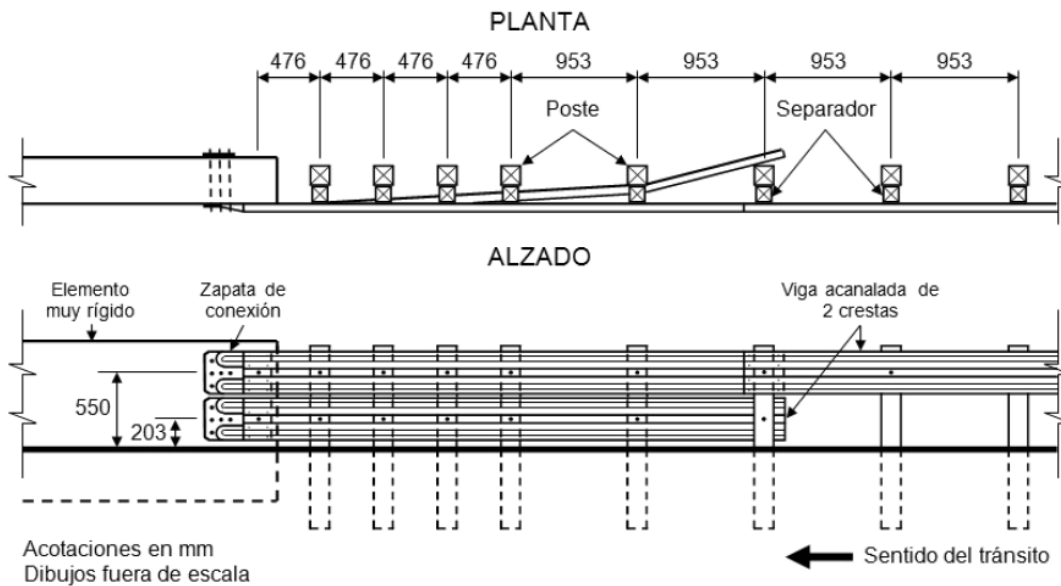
Transición de barrera metálica de doble banda a muro vertical recto
